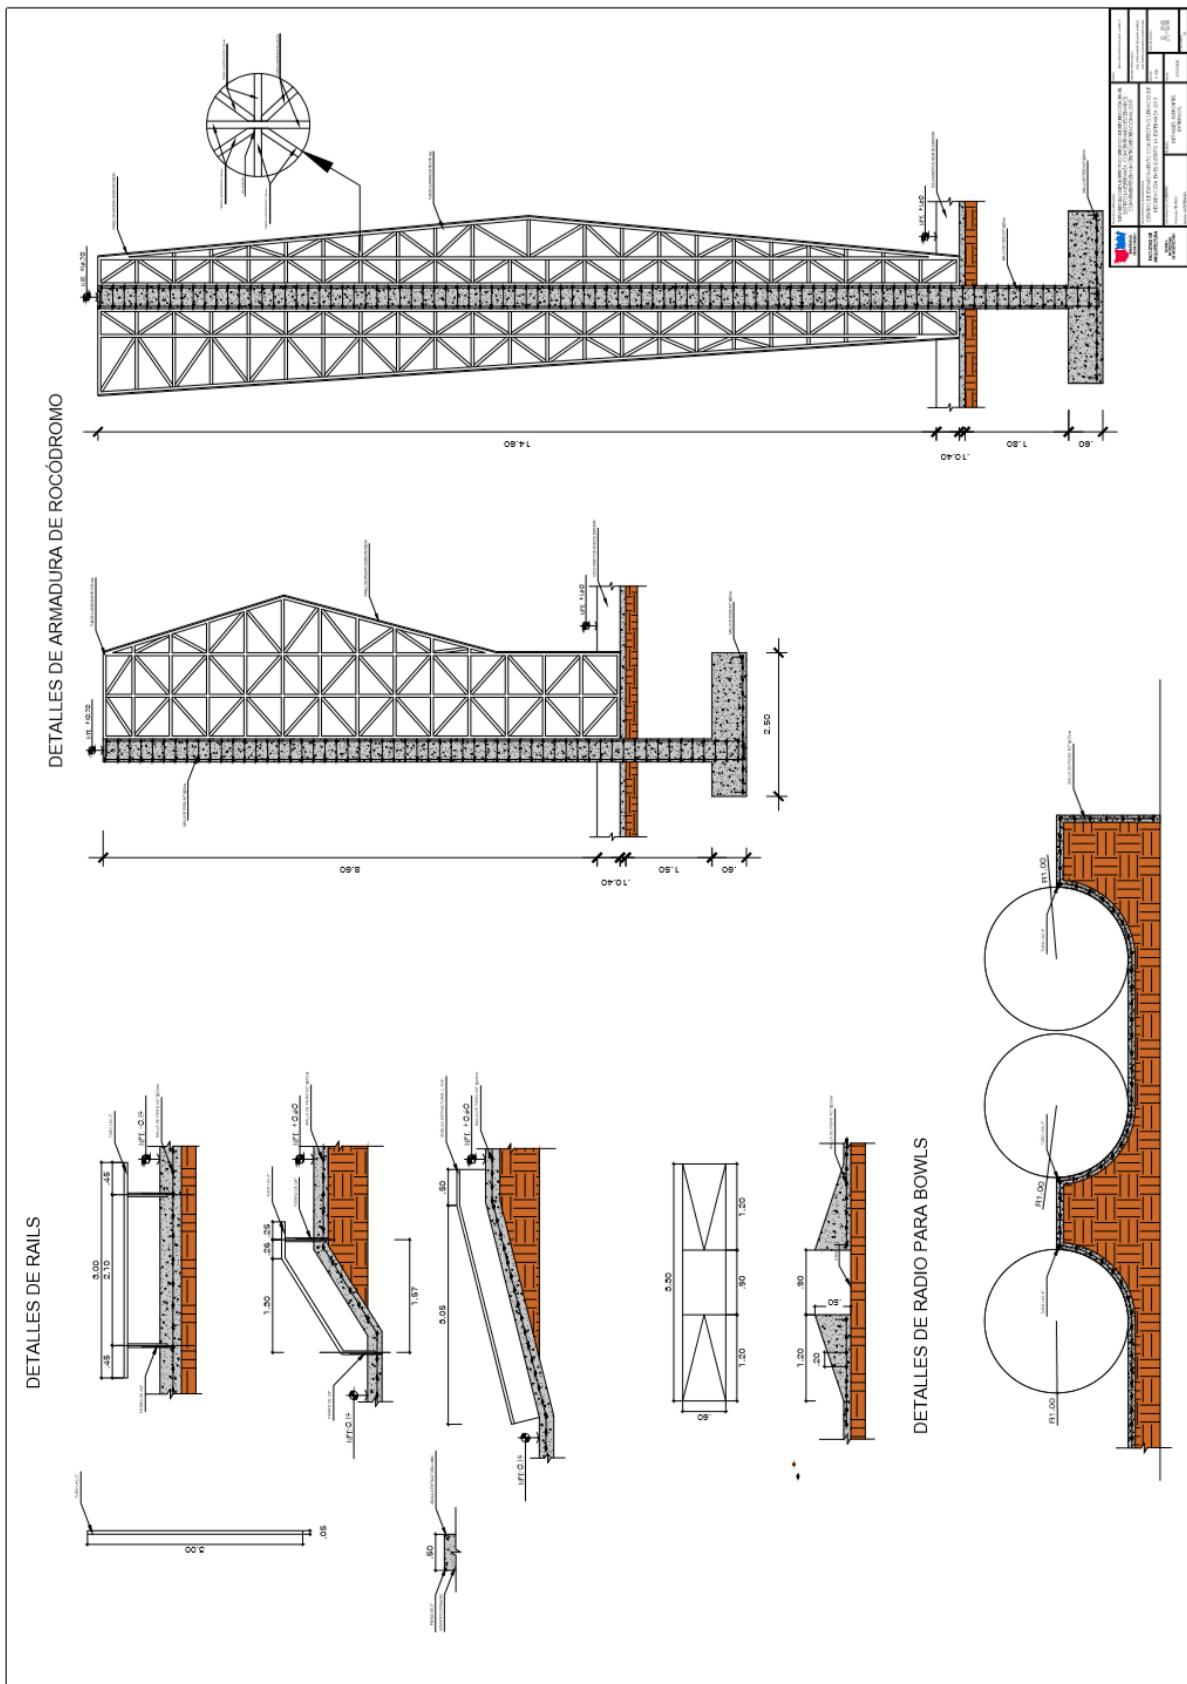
Plano de Detalles de Zona de Deportes Extremos. Elaboración propia
